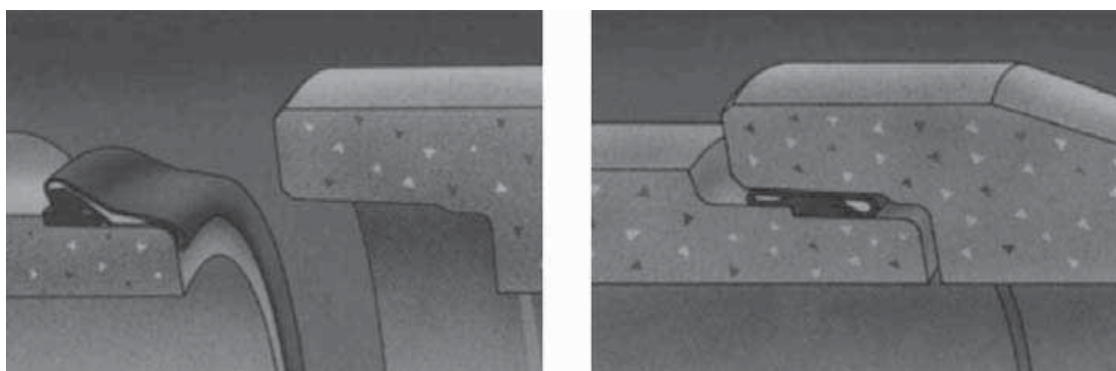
Diferentes tipos de uniones y de juntas para tuberías de hormigón armado.
